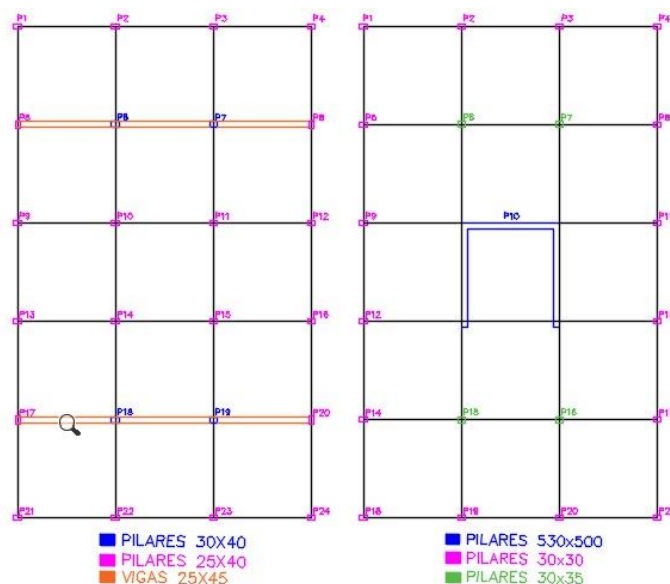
Distribuição dos Elementos Estruturais com auxílio do AutoCad (Fonte: Próprio Autor).
